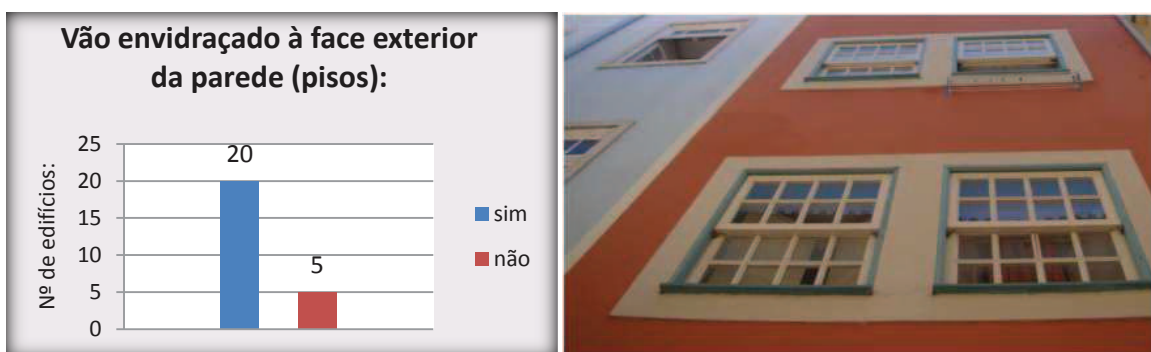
Implantação do vão na parede dos pisos e exemplos de janelas junto à face exterior.
